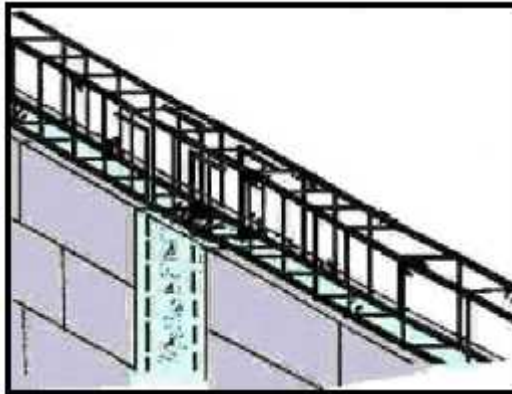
Estribos en vigas de confinamiento Figura 7.28: Cubos de mortero
